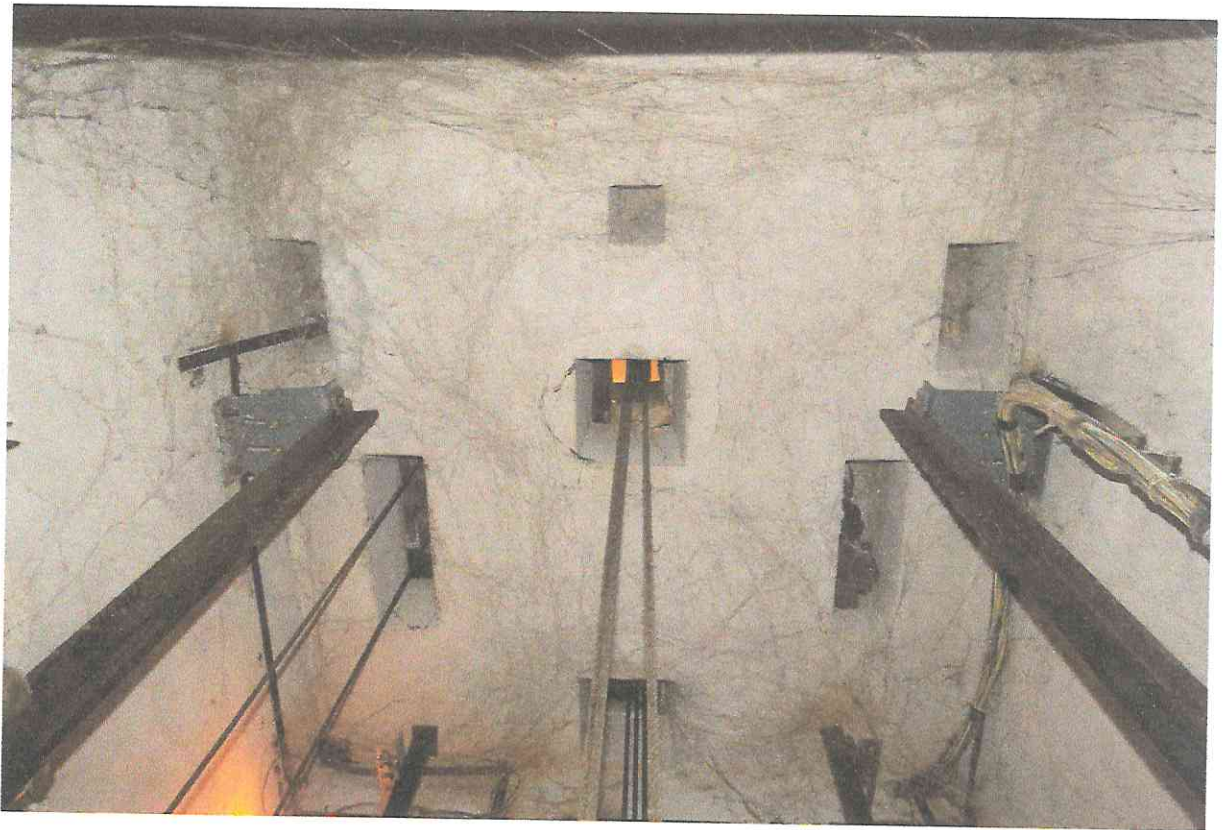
Вид на плиту перекрытия лифтовой шахты 3 подъезда
